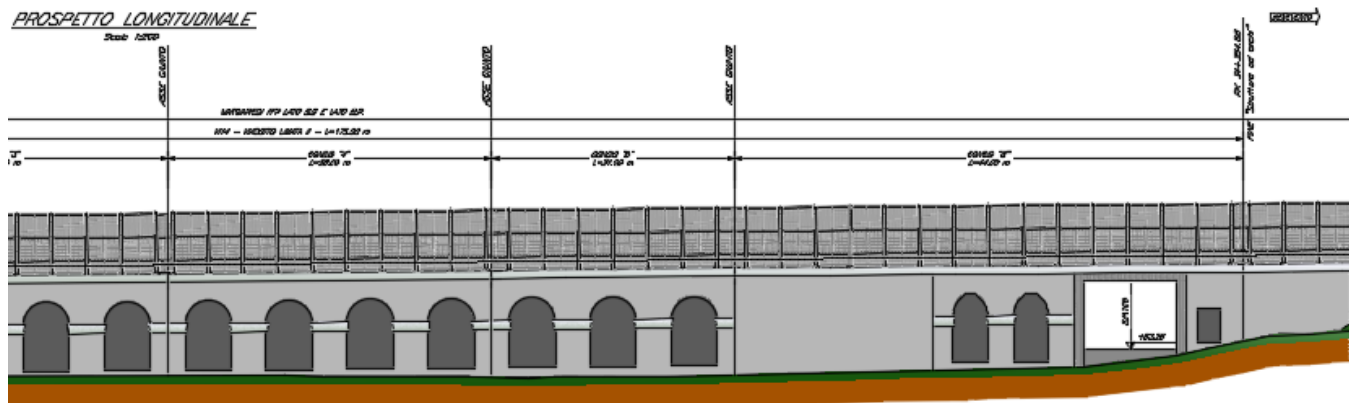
Prospetto del VI14 2 di 2 - “struttura ad archi”
